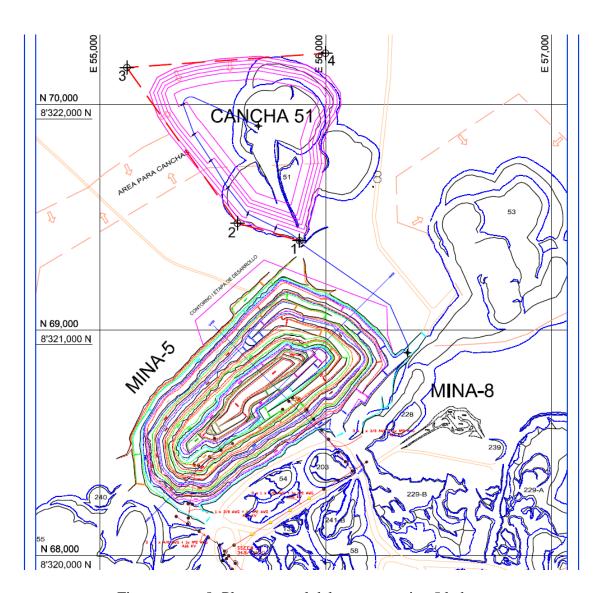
Plano general del proyecto mina 5 lado norte
